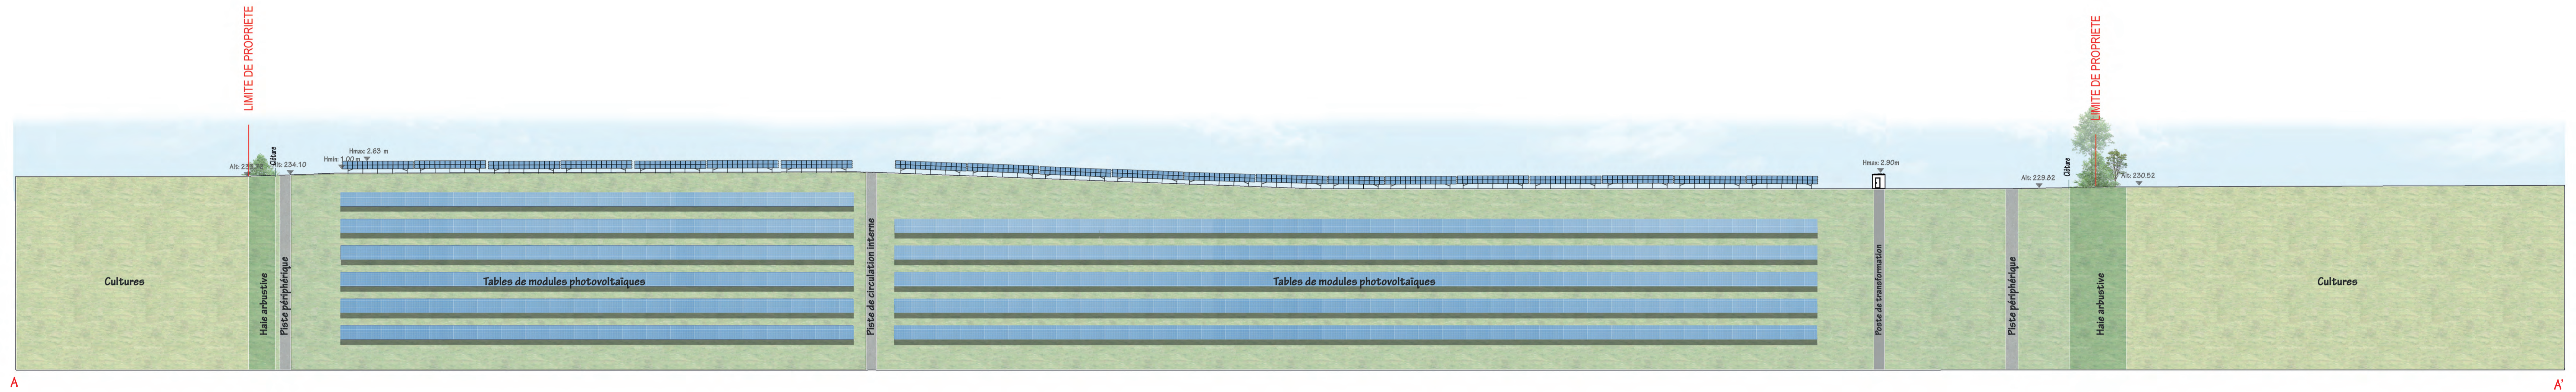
COUPE LONGITUDINALE DES STRUCTURES PHOTOVOLTAIQUES - échelle 1/60e
